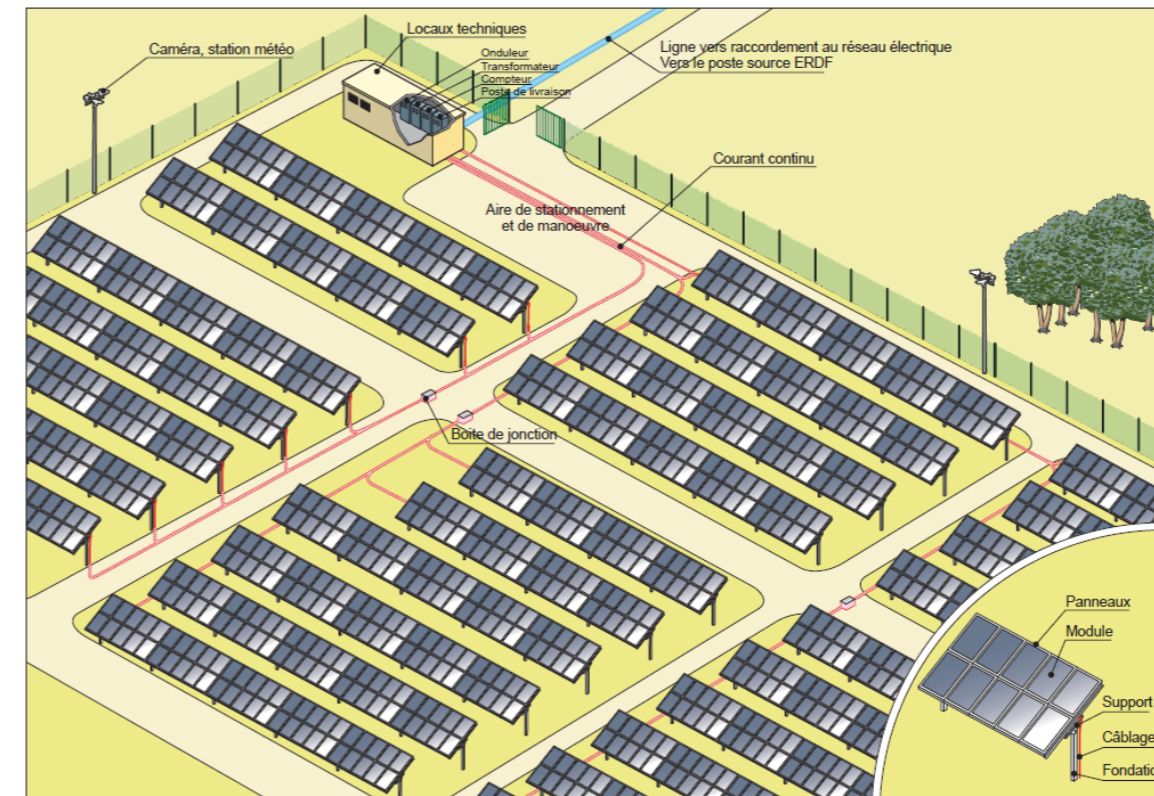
Schéma de principe d'une installation photovoltaïque (source : Guide de l'étude d'impact – Installations photovoltaïques au sol – MEDDTL, avril 2011)
